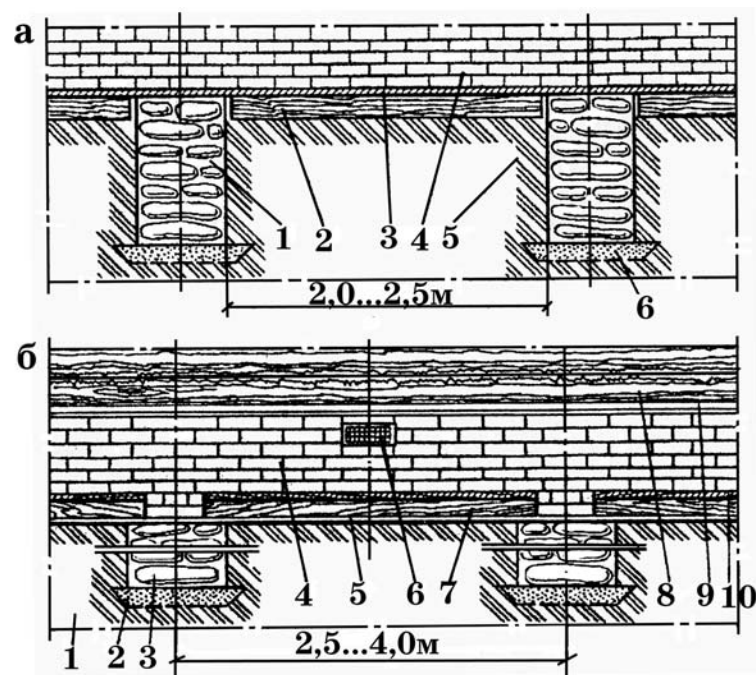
Устройство пролетов столбчатого фундамента: а — фундамент с рандбалкой: 1 — столб; 2 — доска; 3 — слой цементного раствора; 4 — рандбалка; 5 — материковый грунт основания; 6 — песчаная подушка; б — кирпичная кладка по деревянной балке: 1 — материковый грунт основания; 2 — песчаная подушка; 3 — бутовый постелистый камень; 4 — кирпичная перемычка; 5 — зазор (5–7 см); 6 — вентиляционное отверстие; 7 — деревянная балка; 8 — бревна стены; 9 — полочка слива цоколя; 10 — цементно-песчаный раствор.
